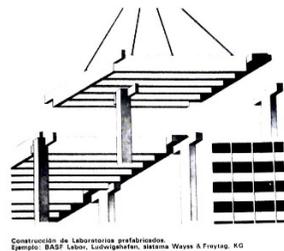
representación de montaje sistema prefabricado de vigas y columnas (Smith, Timberlake, and Smith 2010)
